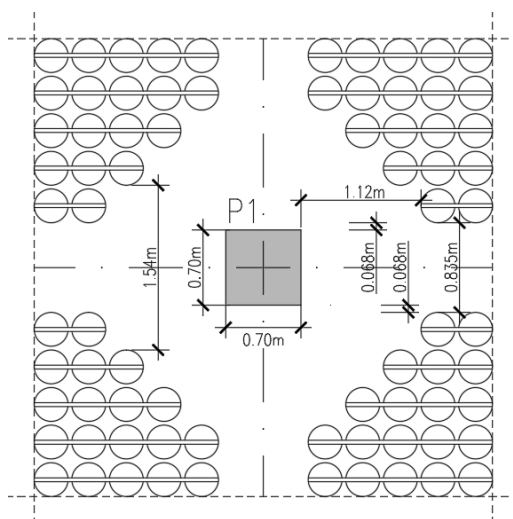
Pormenor construtivo na zona dos pilares centrais.
